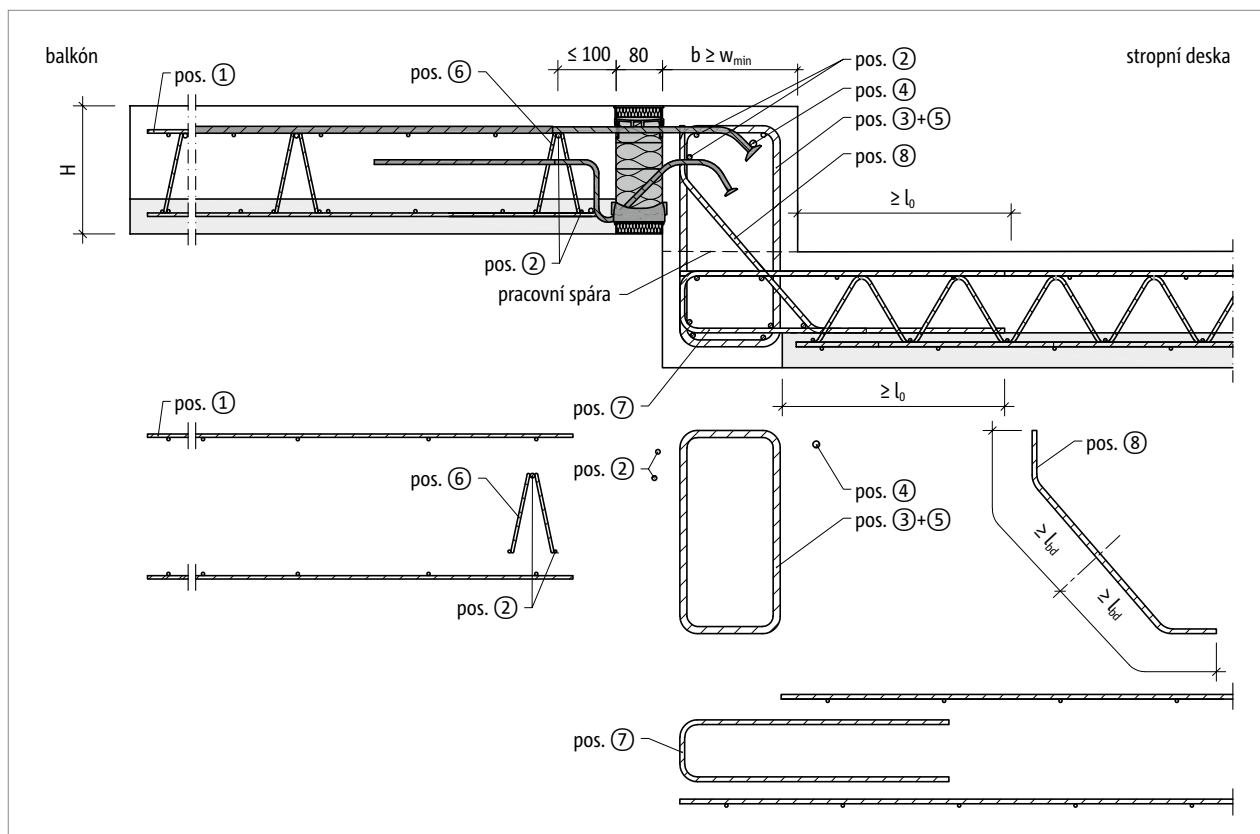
Schöck Isokorb® T typ KL-O-F: Napojovací stavební výztuž pro desku kotvenou do stěny pod úroveň balkónu
